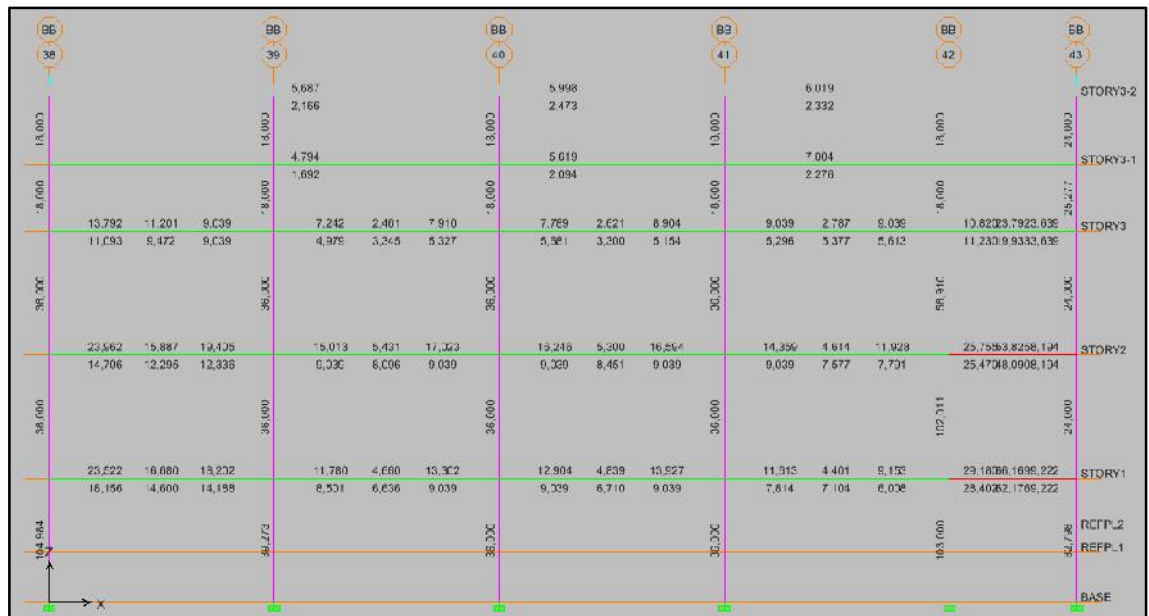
Acero en vigas pórtico BB, Consulta Externa II
